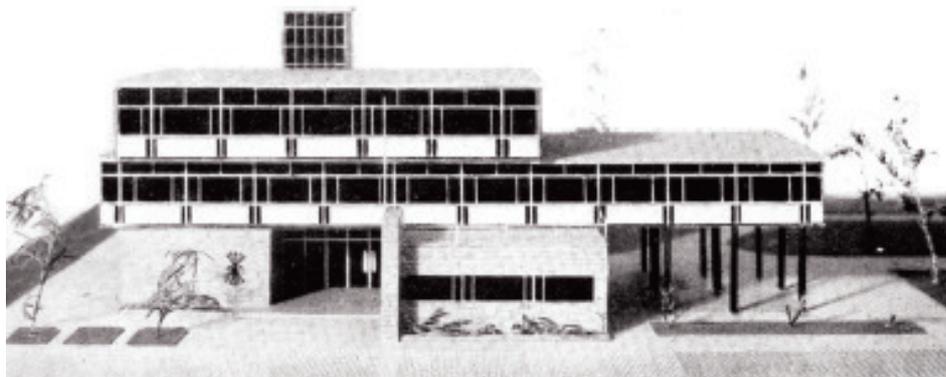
Casa Sindical. Maqueta de proyecto.
